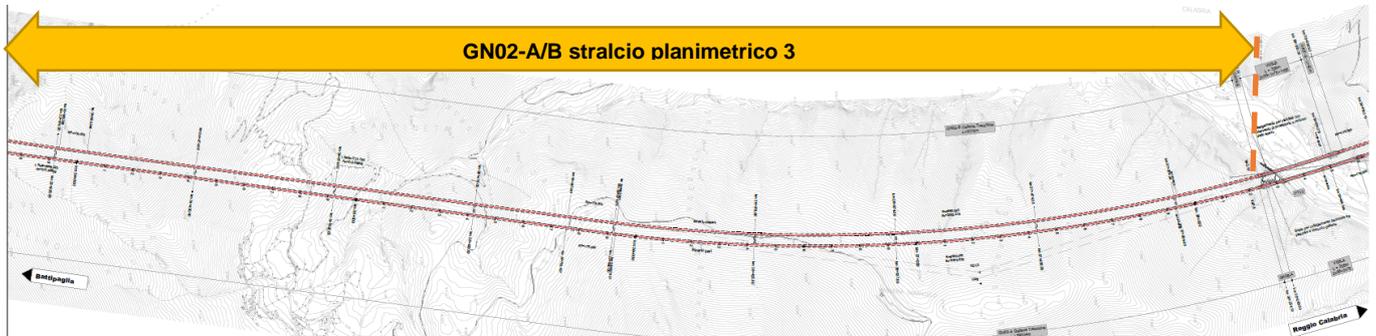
Planimetrie di progetto gallerie GN02-A/B da km 28+646 al km 38+260 BP
